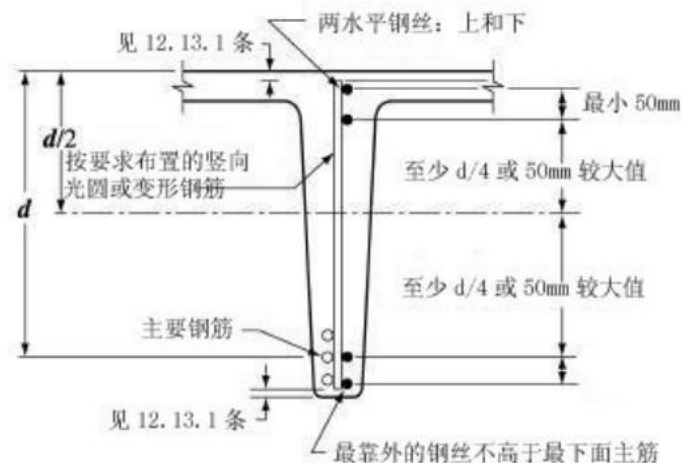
单肢焊接钢丝抗剪钢筋的锚固
